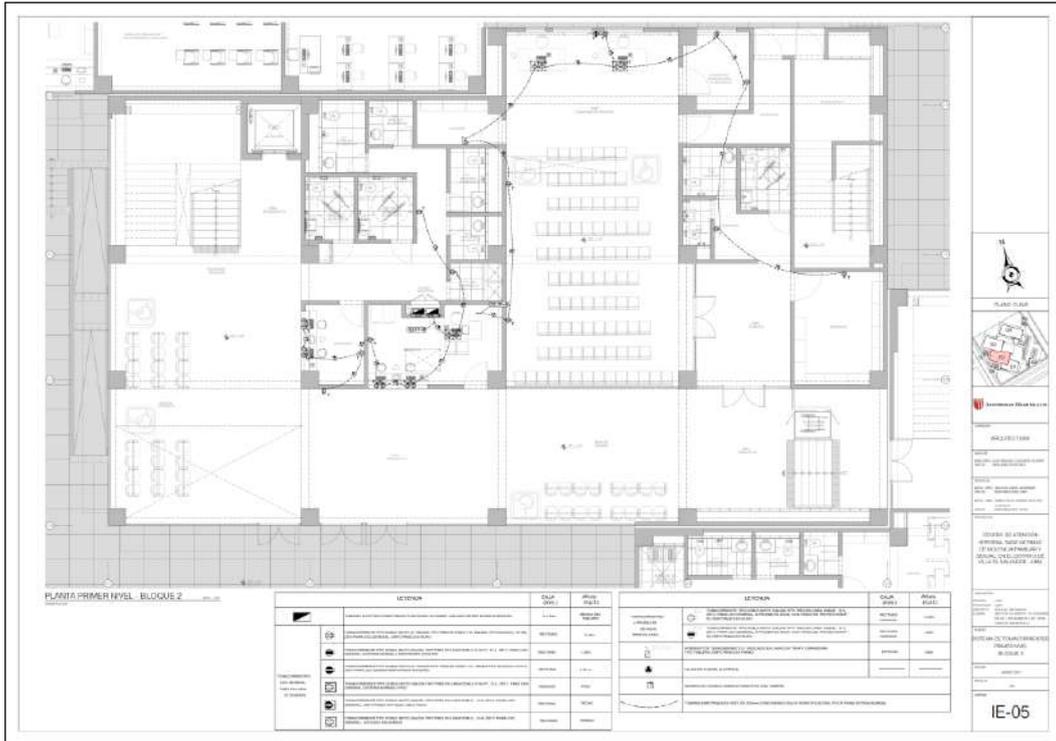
Planta primer nivel sistema de tomacorrientes – bloque 2.
